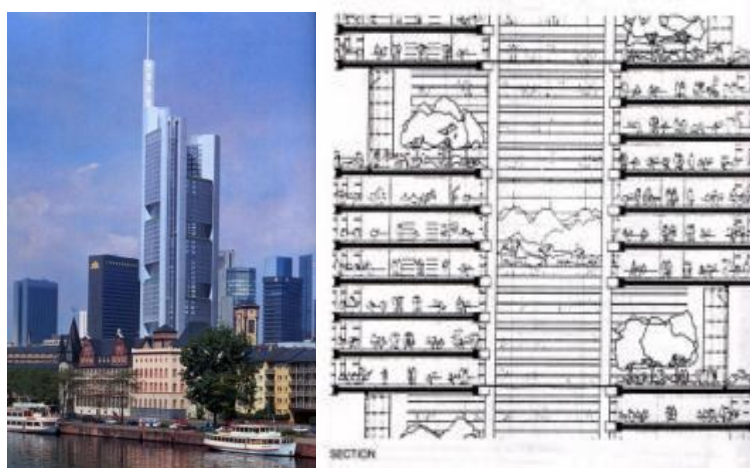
Contoh penerapan elemen landskap pada Bangunan G Tower
